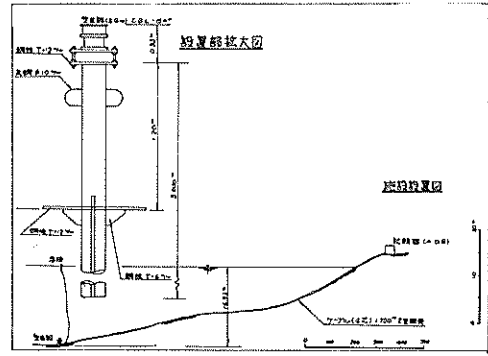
八戸港 (A地点) 波高計設置要領図 (断面図)
